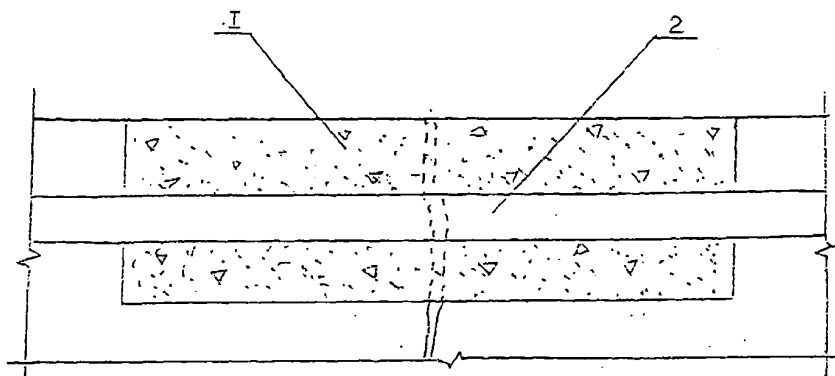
Схема восстановления монолитности железобетонной конструкции фибробетоном ЭМАКО. 1 – фибробетон, 2 – арматура.
